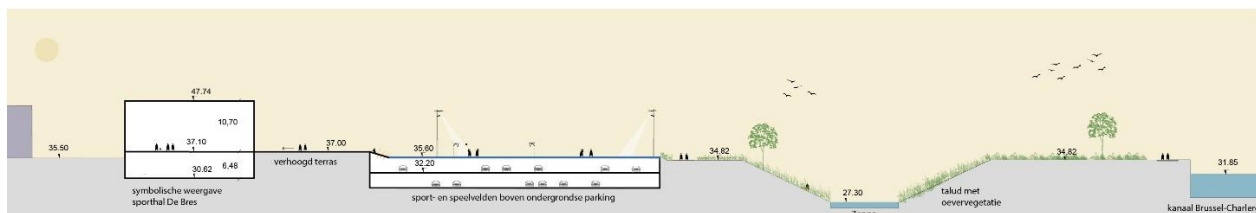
Snede inrichtingsalternatief – ondergrondse parking onder sporthal en buitenruimte
